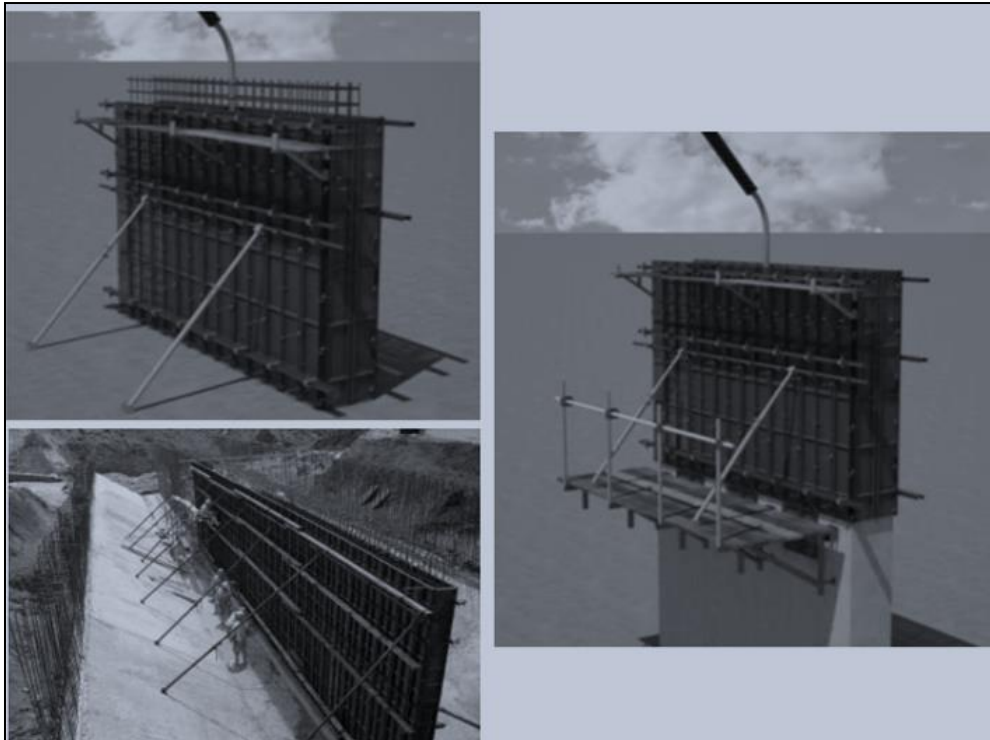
Sistema de pantallas y columnas con formaleta metálica
